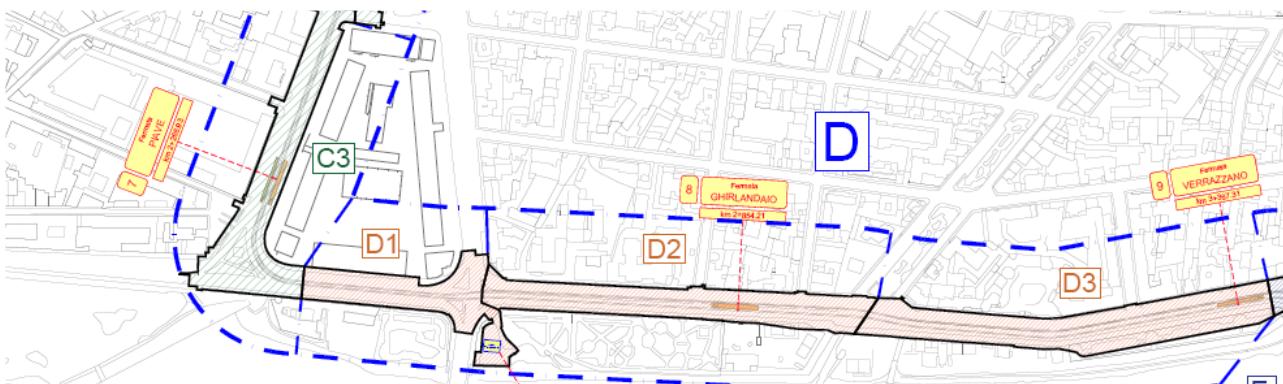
Macrocantiere D e suddivisione in cantieri – Estratto da elaborato 321GEN00006PE – Relazione Generale
